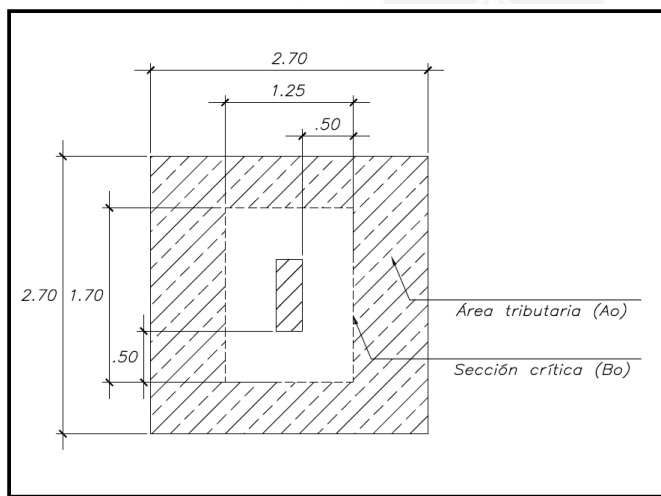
Dimensiones zapata aislada para verificaciones por punzonamiento. Dimensiones en metros.
